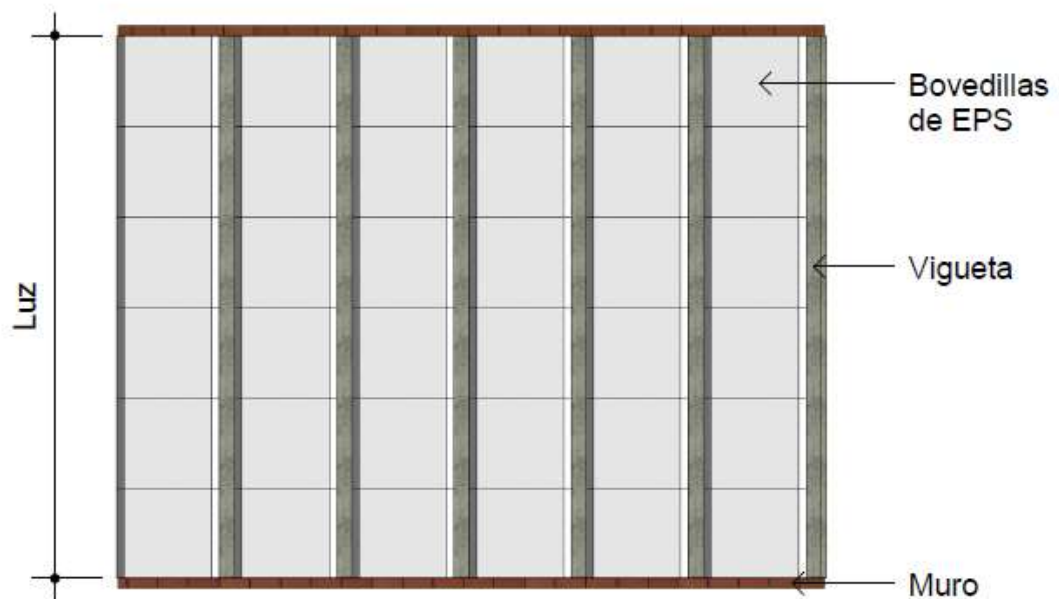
Planta tipo Solución Vigueta-Bovedilla
